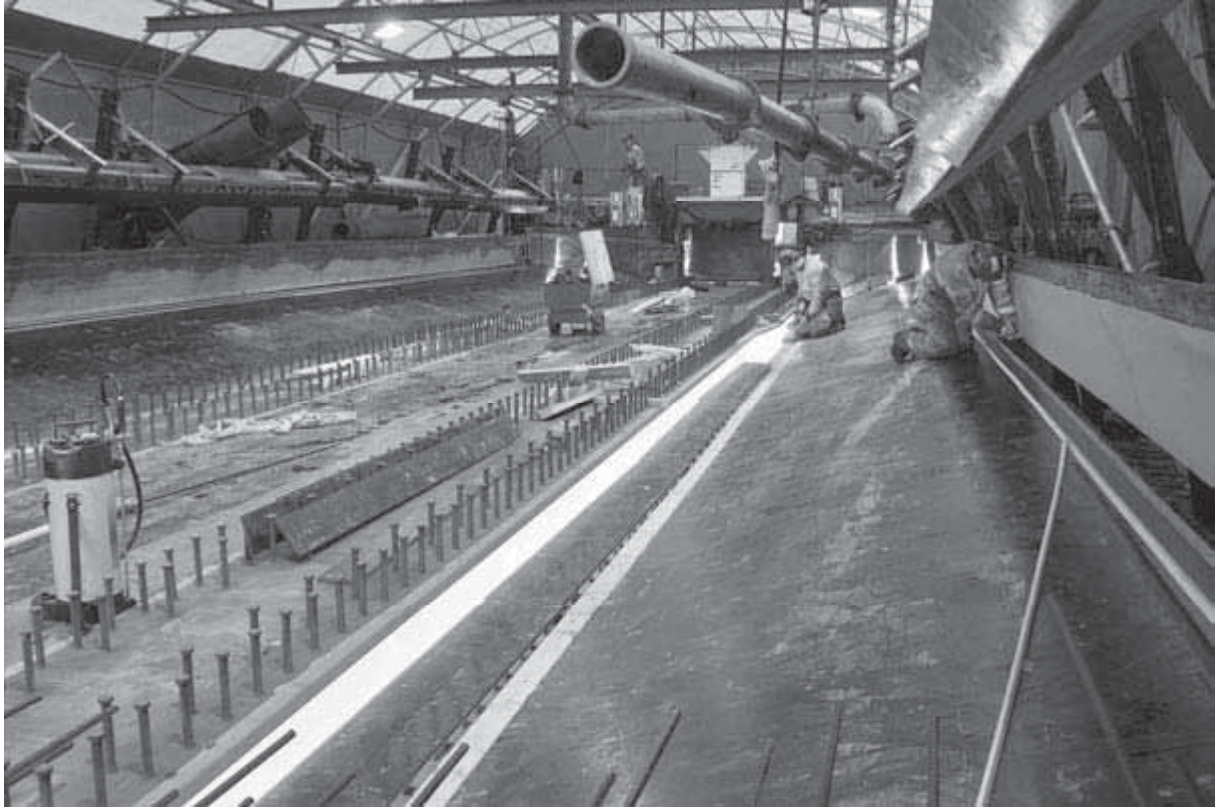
Photo du pont sur le Veckefjärden pendant la construction en hiver.
